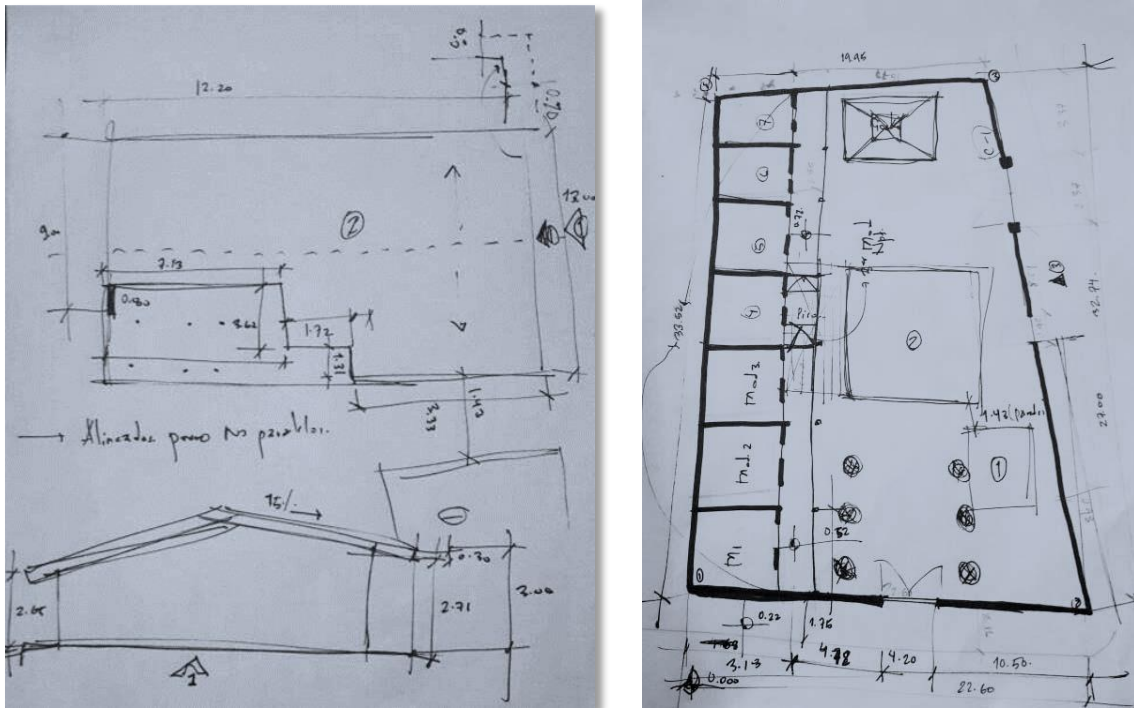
De izquierda a derecha: Esquemas de levantamiento planta de edificio de antiguo centro de salud, y planta de conjunto. Fuente: Elaboración Propia, 2017
